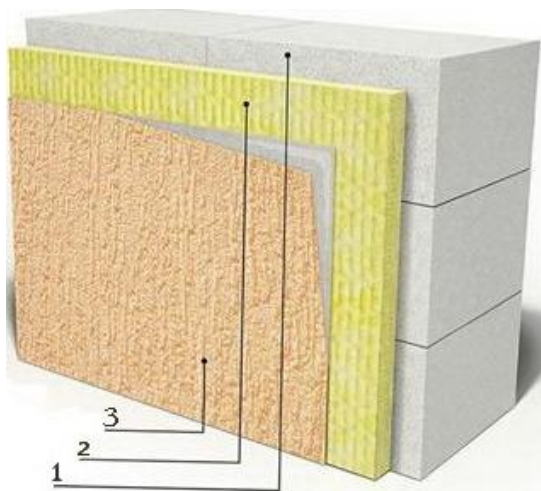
Основные слои внешних стен: 1 – железобетон; 2 – плиты утеплителя из пенополистирола; 3 – грунтовка и фасадная (минеральная) штукатурка
